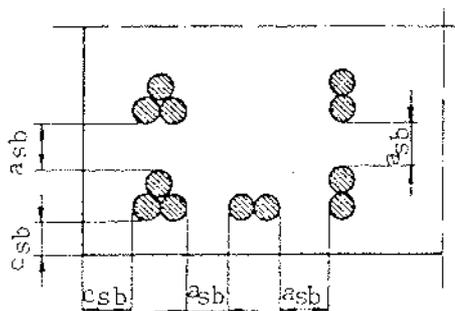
Disposición, separación mínima y recubrimiento mínimo en paquetes de barras.
